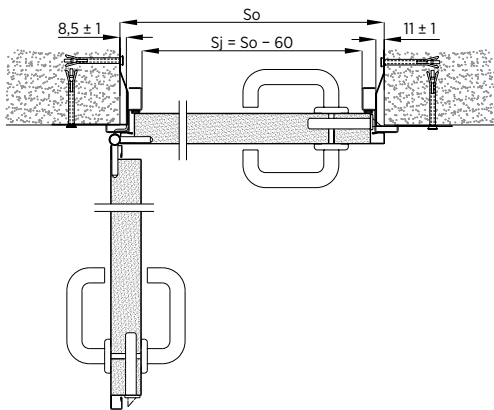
Montage d'un bloc-porte à un battant avec bâti angulaire - coupe horizontale
